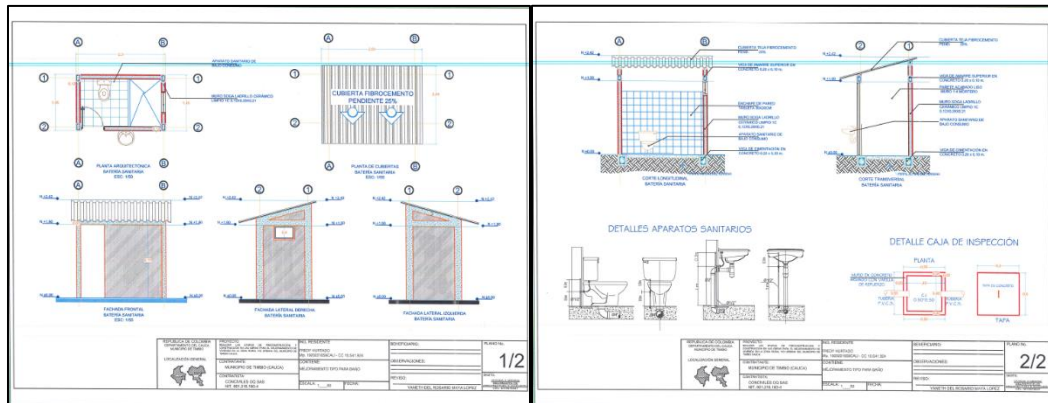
Plano Mantenimiento tipo para Baño (Fuente CONCVILES OQ SAS)
